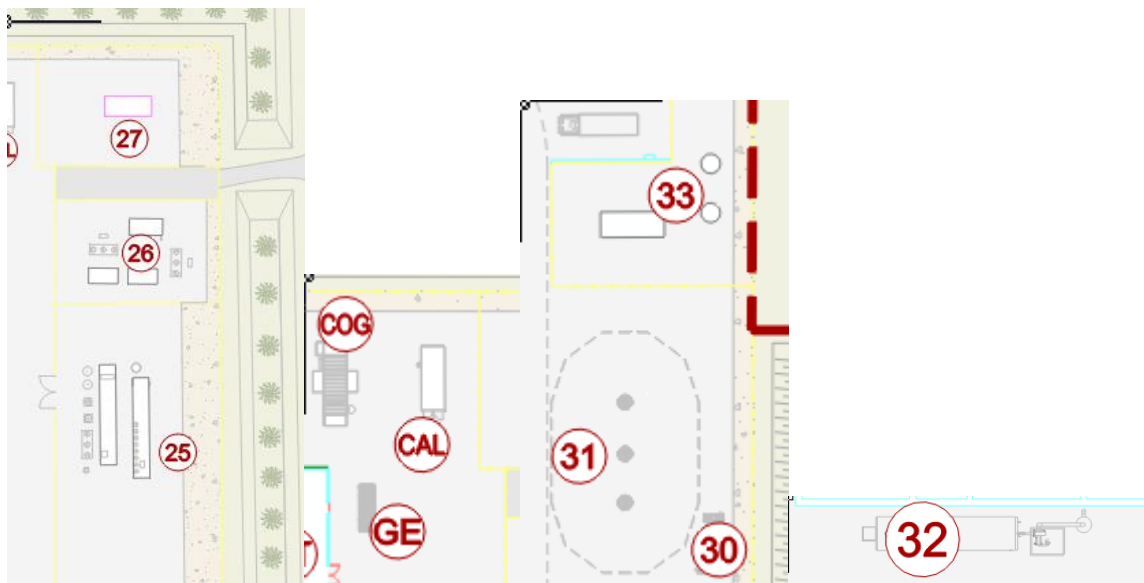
Pianta Interventi 26-27-30-31-32-33
